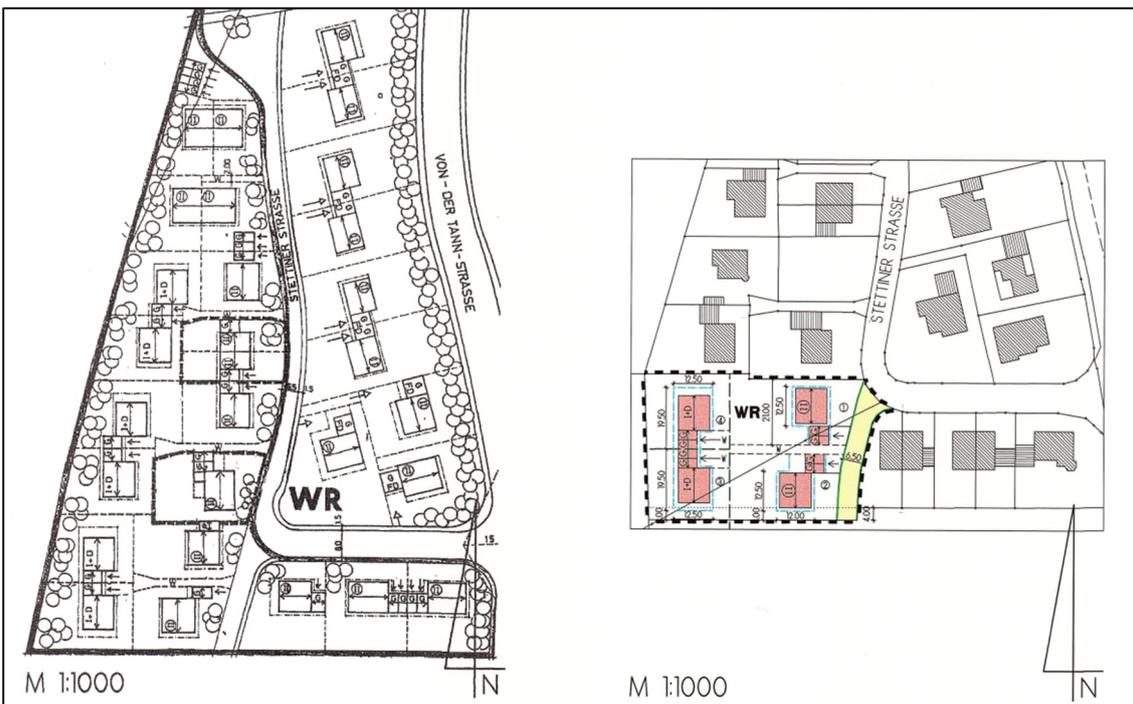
Planzeichnung inkl. 2. Änderung (links) und 3. Änderung (rechts) des Bebauungsplans Nr. 37 „Gebiet westlich der Stettiner Straße“ der Stadt Waldkraiburg /11/
